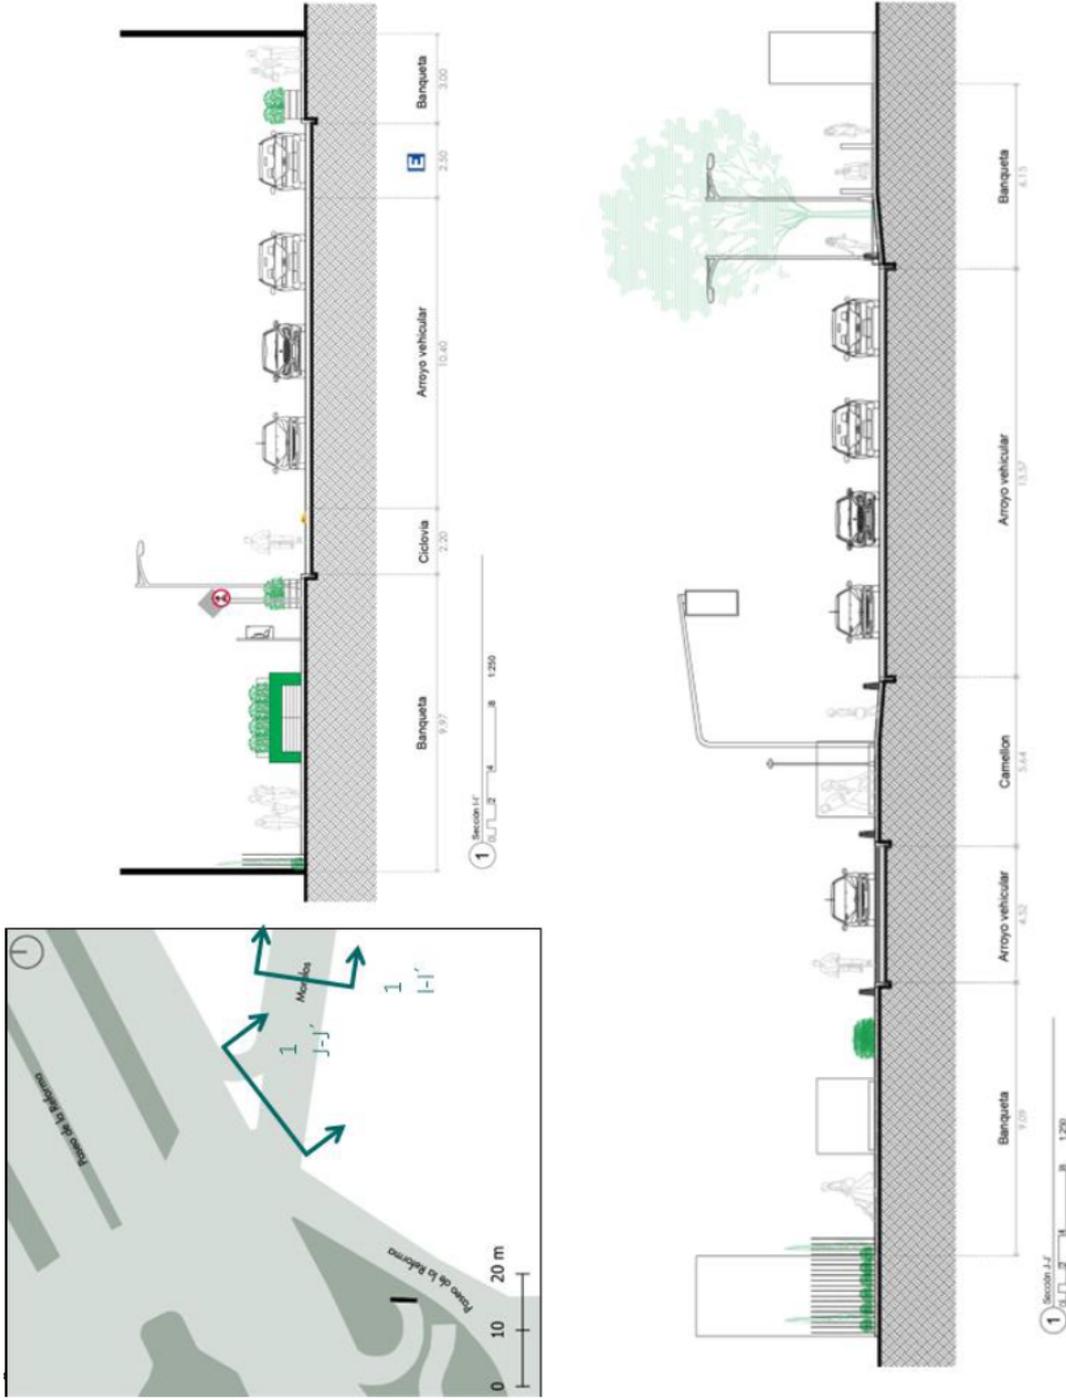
Secciones transversales I-I' y J-J'. Fuente TEUP
